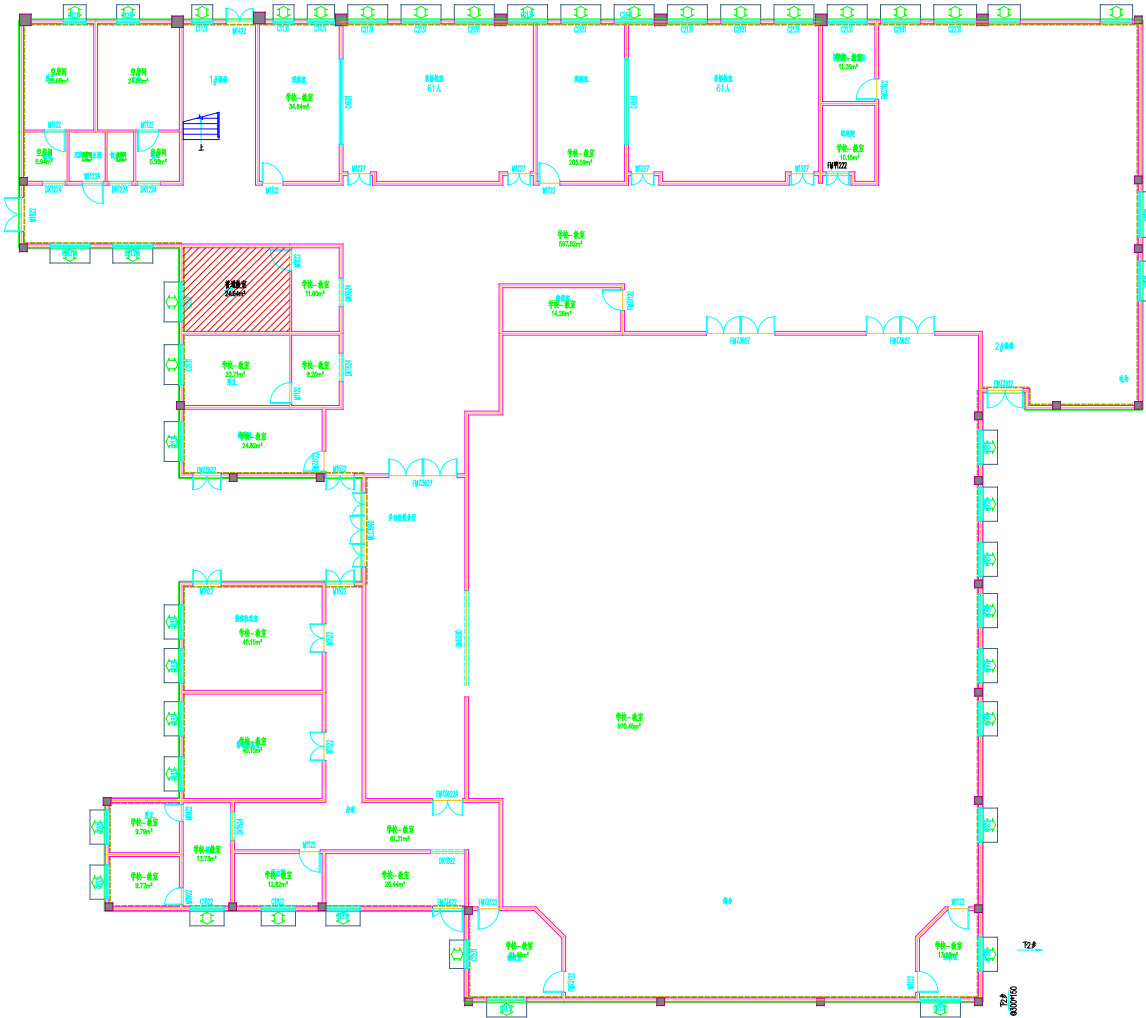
受建筑内设备噪声影响的典型房间楼层平面图
